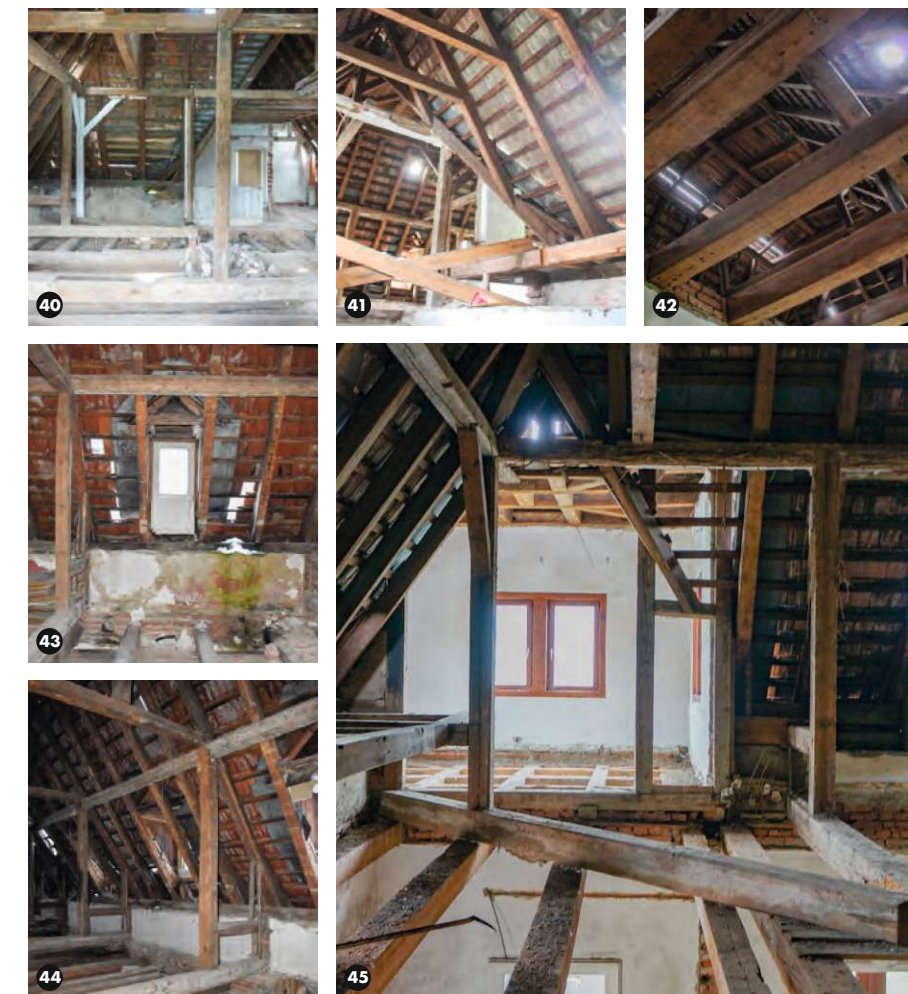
| Fotocollage (40-45); Innenraum Dachgeschoss (2021)
